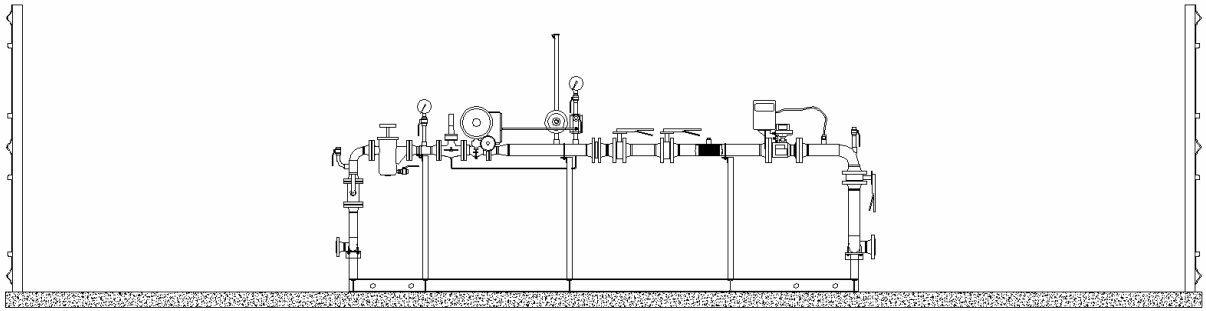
Exemplo de estação EMRP EM-22, com base de concreto e alambrado metálico
